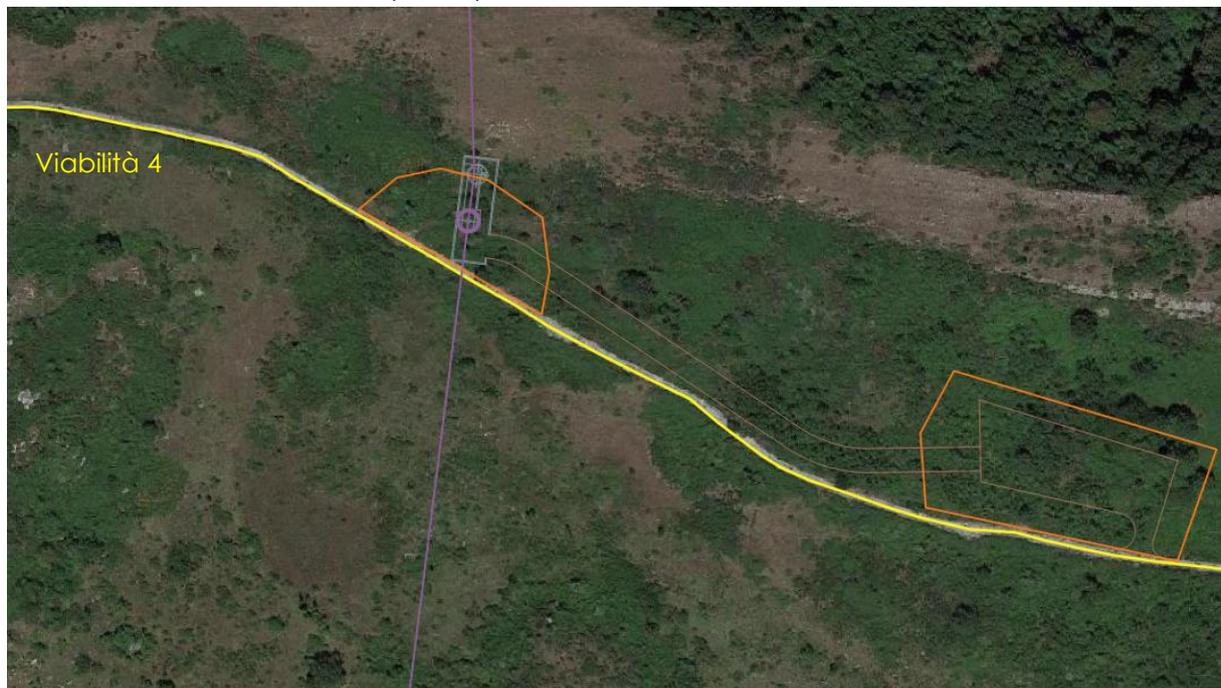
Cantiere Pozzo Piezometrico (Perimetro Arancione)
